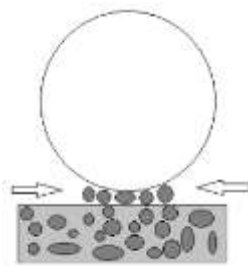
Fijar la estructura a la base con piedras (vista frontal).
